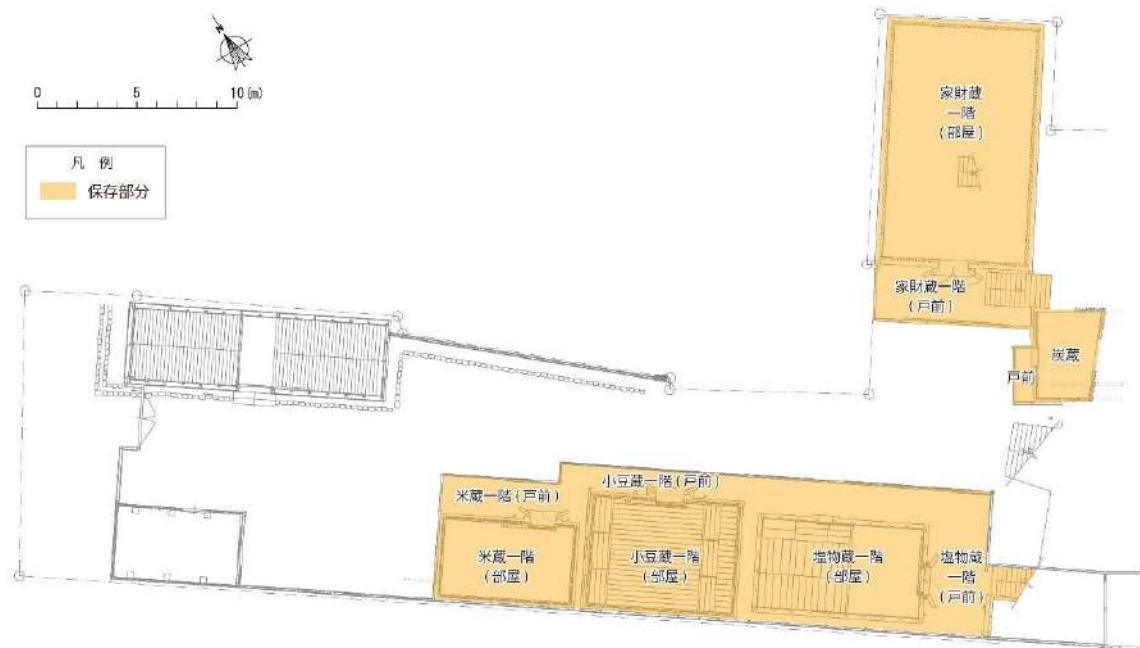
主屋（炭蔵）地階、家財蔵一階、塩物蔵一階、小豆蔵一階、米蔵一階 平面図（部分の設定）
